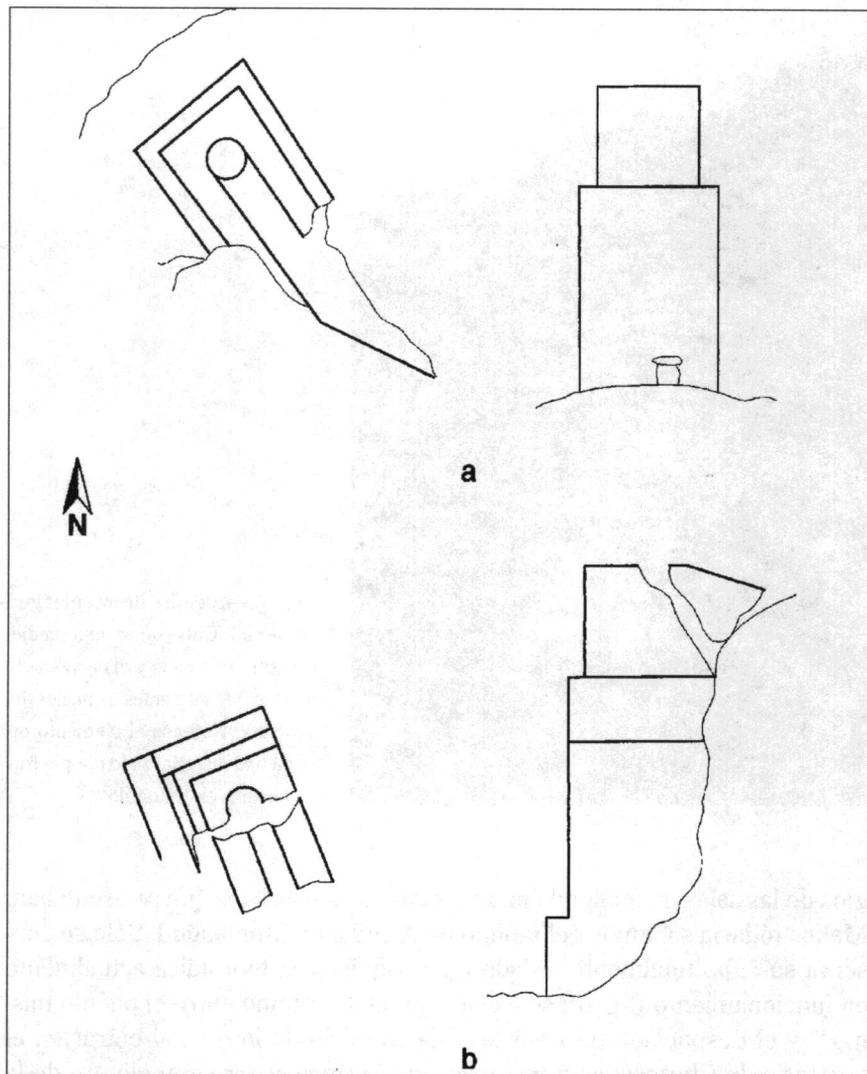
Teresa (Turre, Almería). A: planta y cara frontal del molino superior; B: planta y cara lateral del molino inferior.
